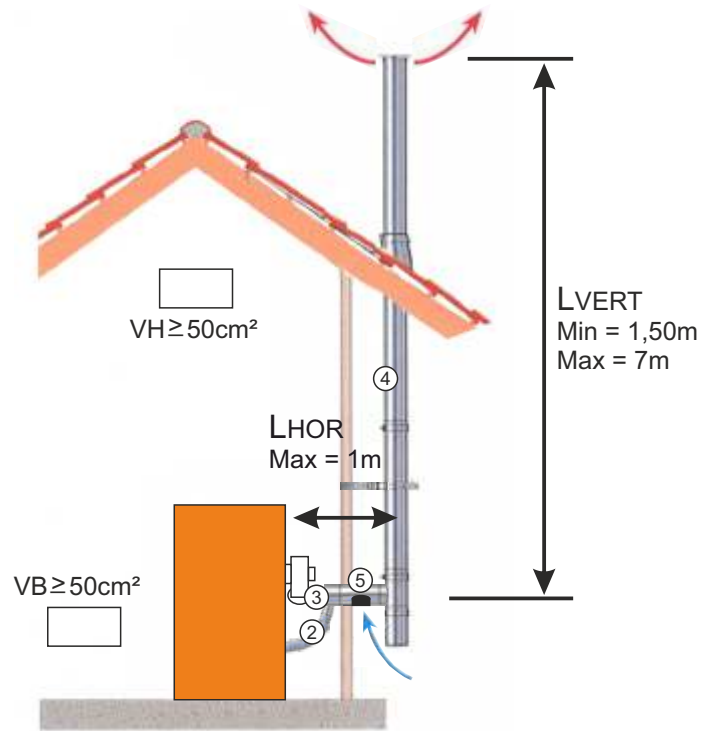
Air frais de la façade - tuyau 130/200 mm
